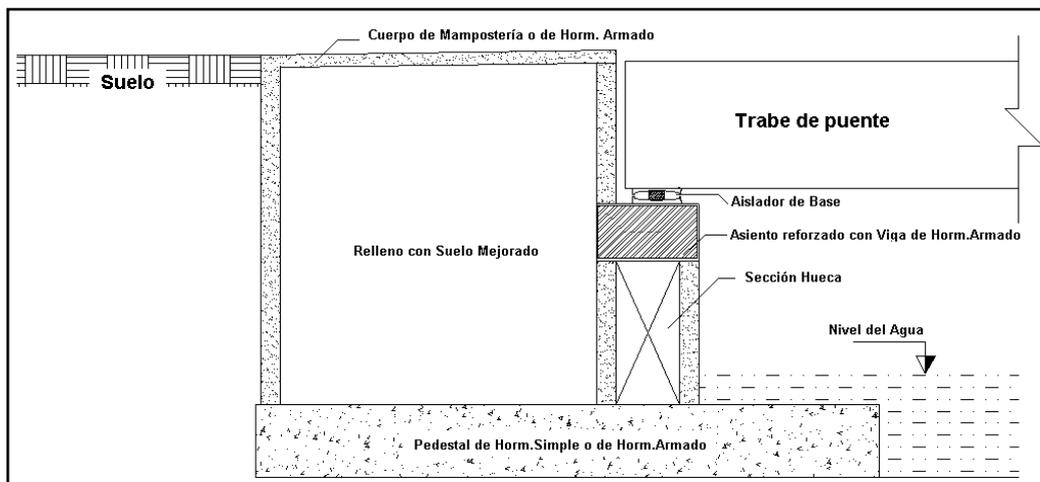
Partes de un estribo (estribo con contrafuertes)
